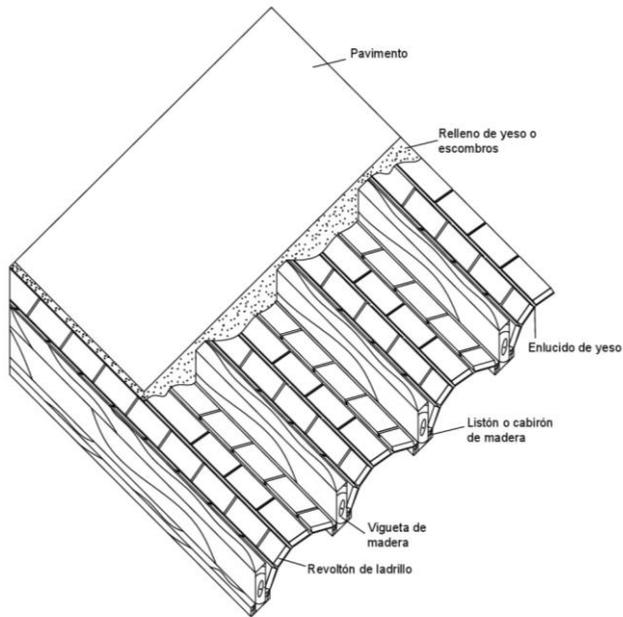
Detalle del Forjado de revoltón. 2018. Fuente: Propia
